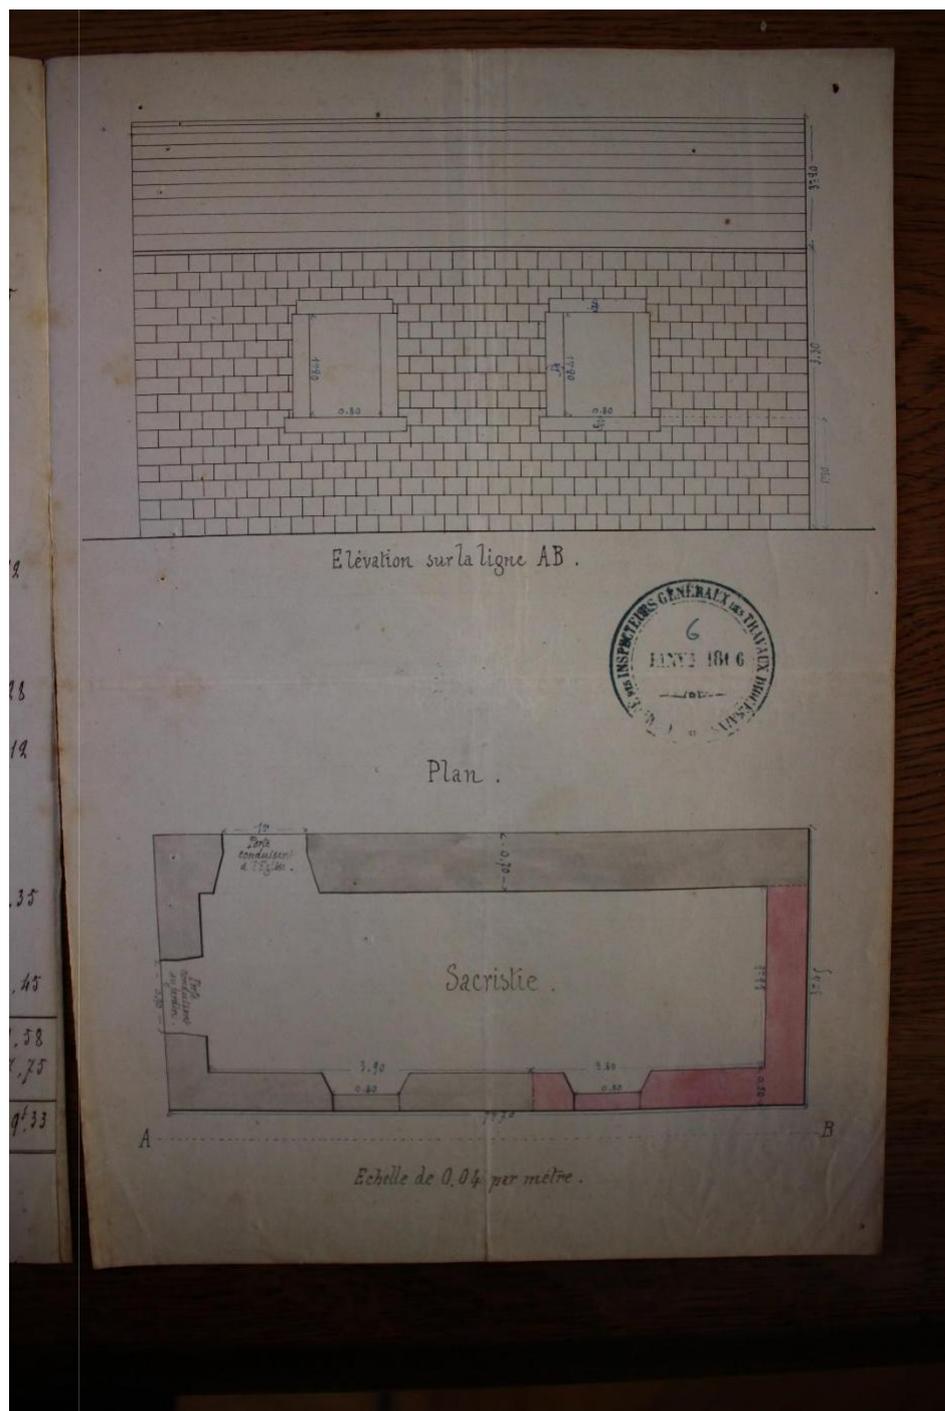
Plan de l'agrandissement de la sacristie en 1866- ADCO, 2 O 520-7
